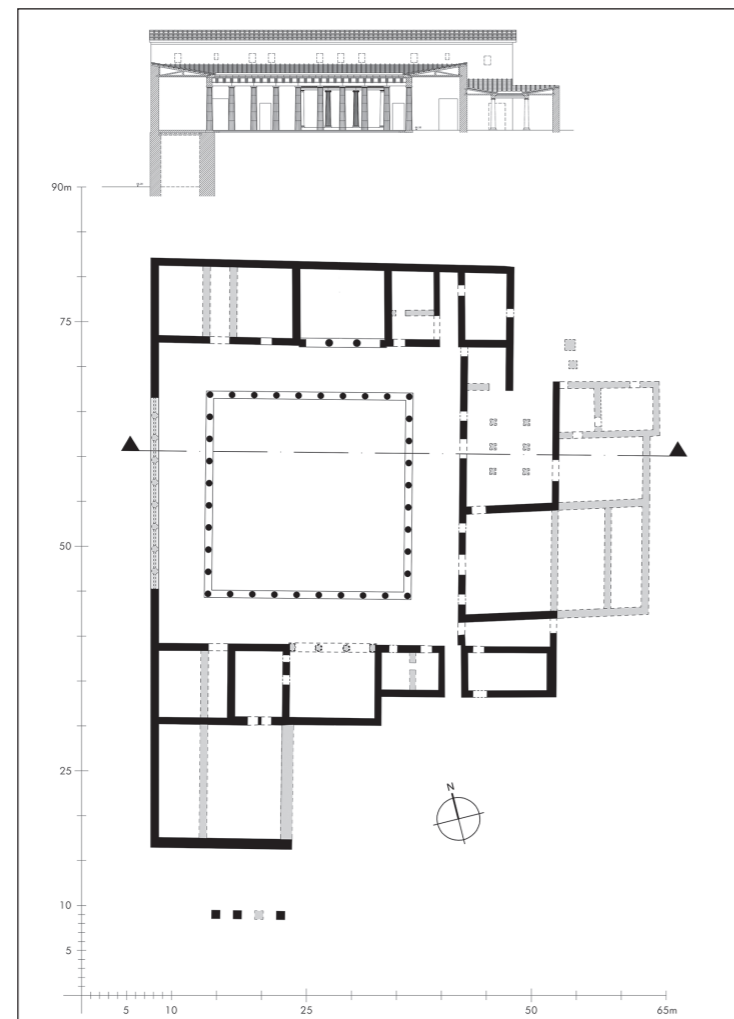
Zeichnerischer Rekonstruktionsvorschlag des hellenistischen Peristylhauses in Grundriss und Schnittansicht (© ÖAW-ÖAI, Pläne: C. Baier)
